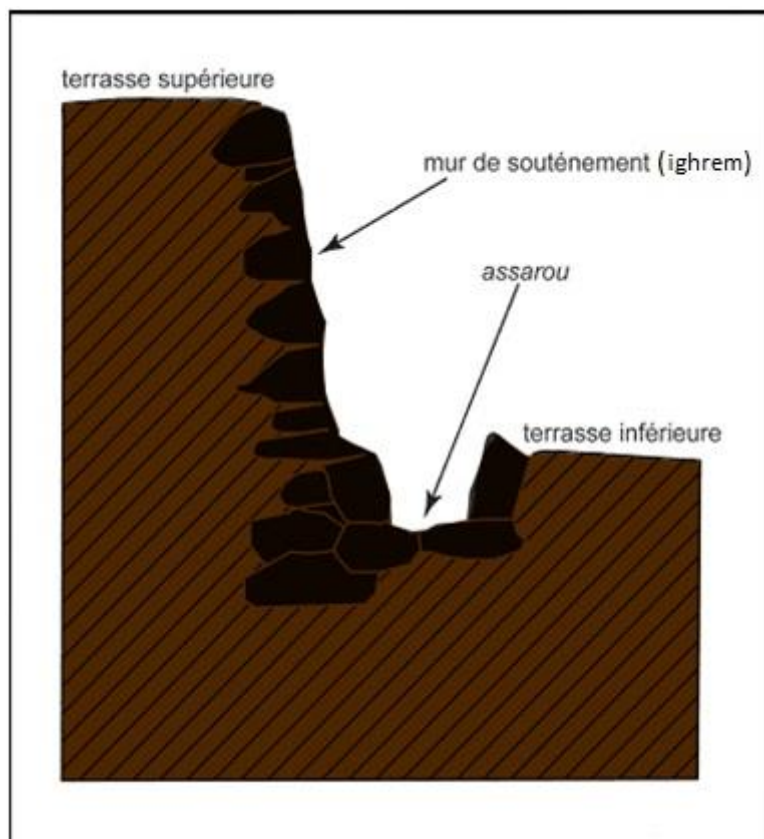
Profil d'un canal secondaire aménagé en champs en terrasses.
